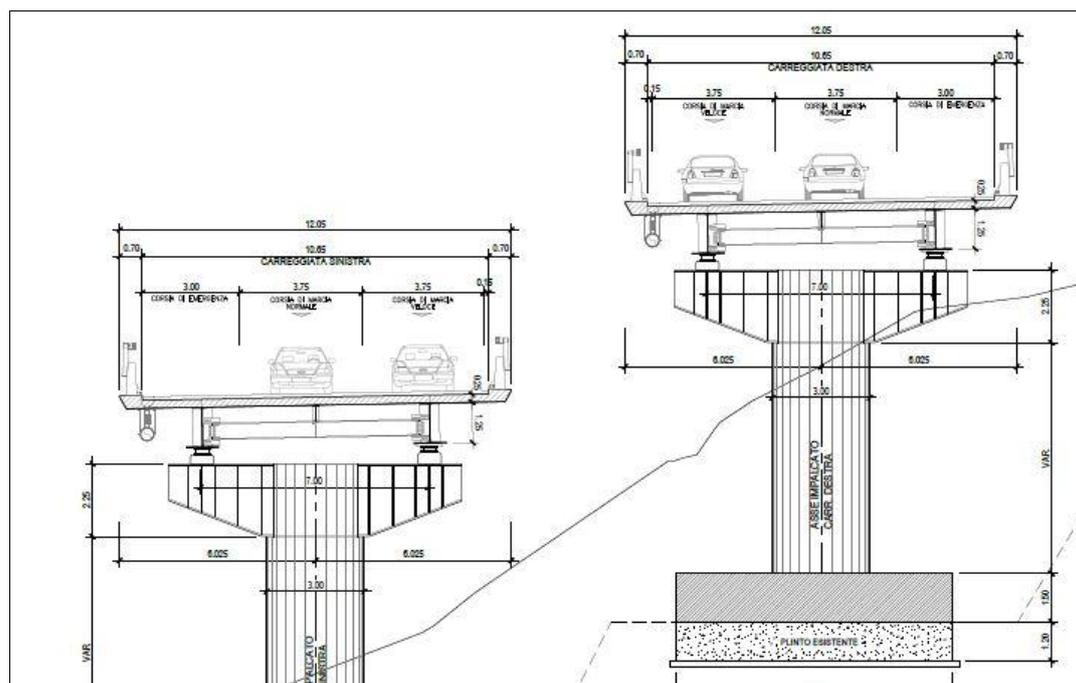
sezione tipo di progetto per carreggiate sfalsate
